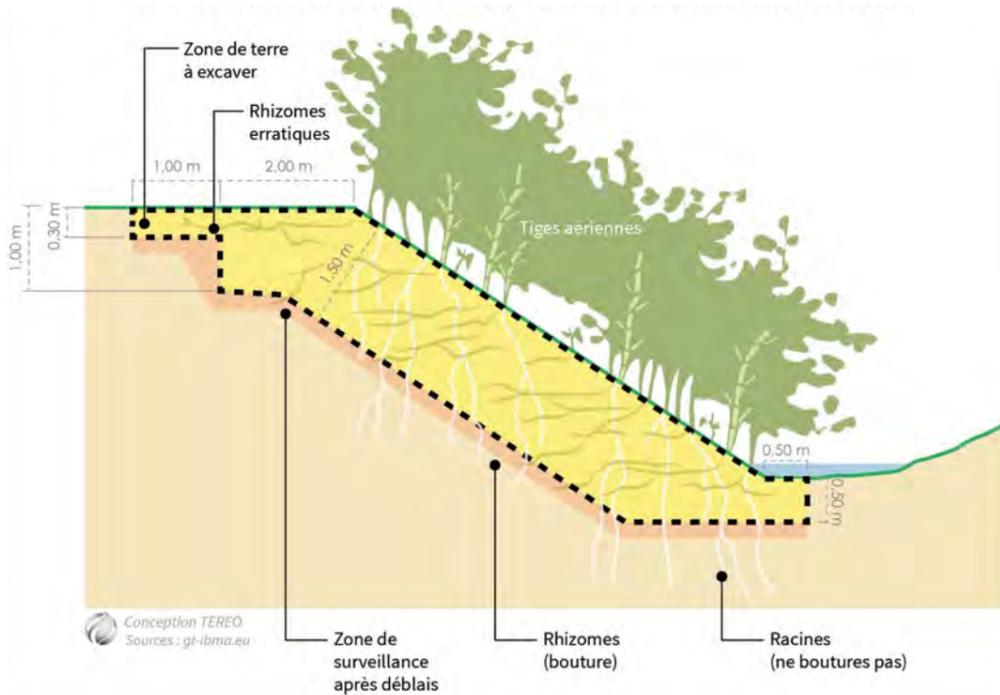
coupe de principe de l'excavation de terres contaminées par la renouée du Japon en berge
